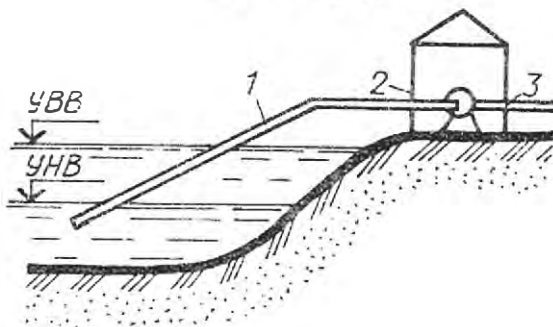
Схема руслового водозабора без водоприемной камеры:
